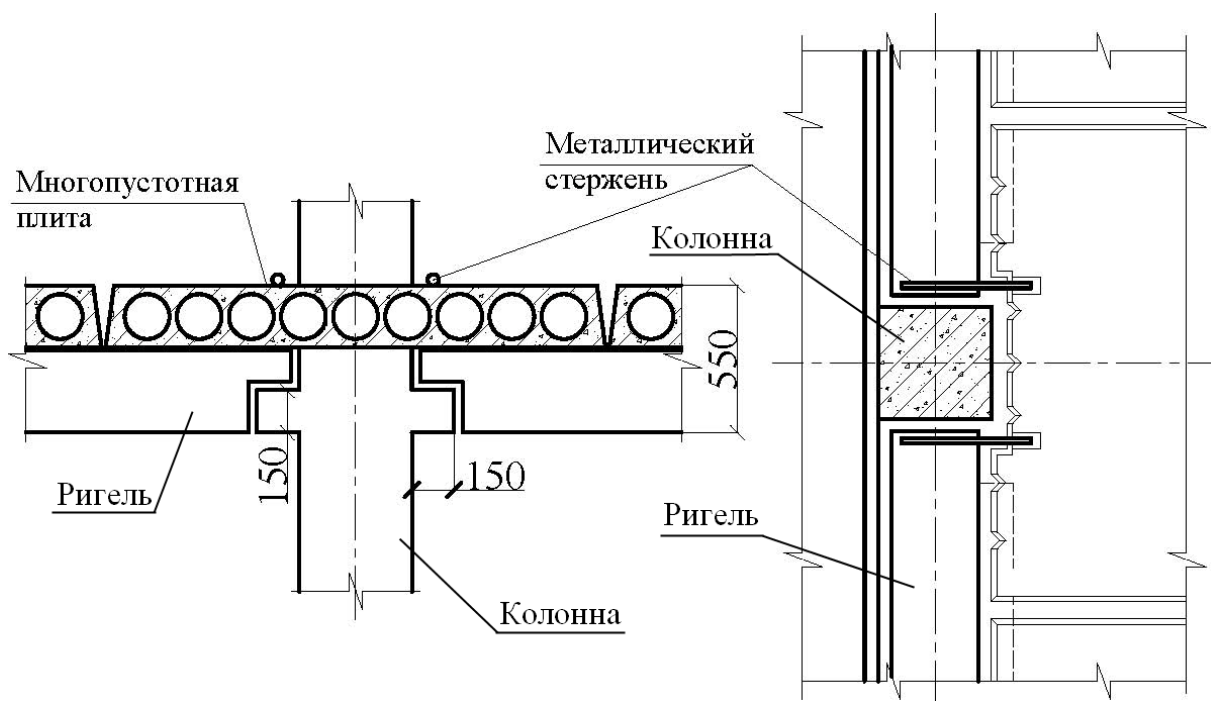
Схема опирания многопустотного перекрытия на ригель по серии 1.041.1-5 [3] с многопустотной межколонной плитой
